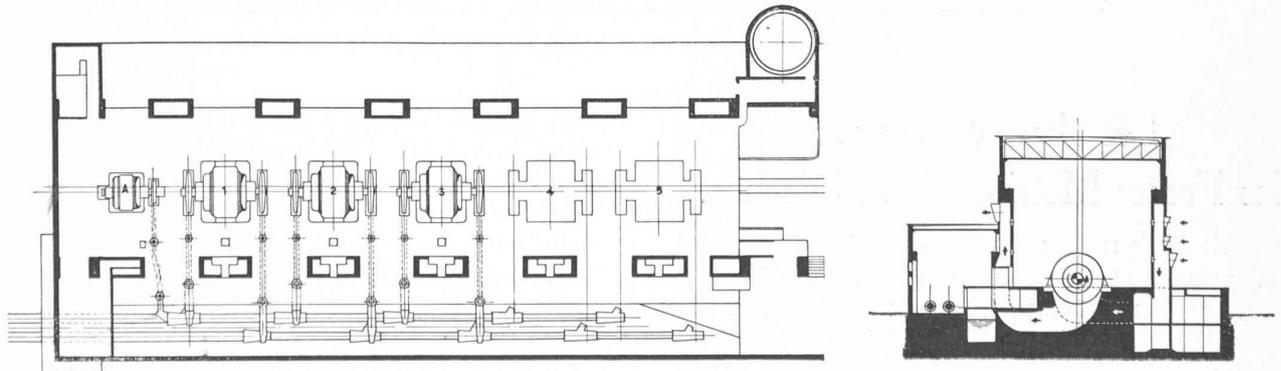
Plans et coupe de la centrale de Chandoline.
